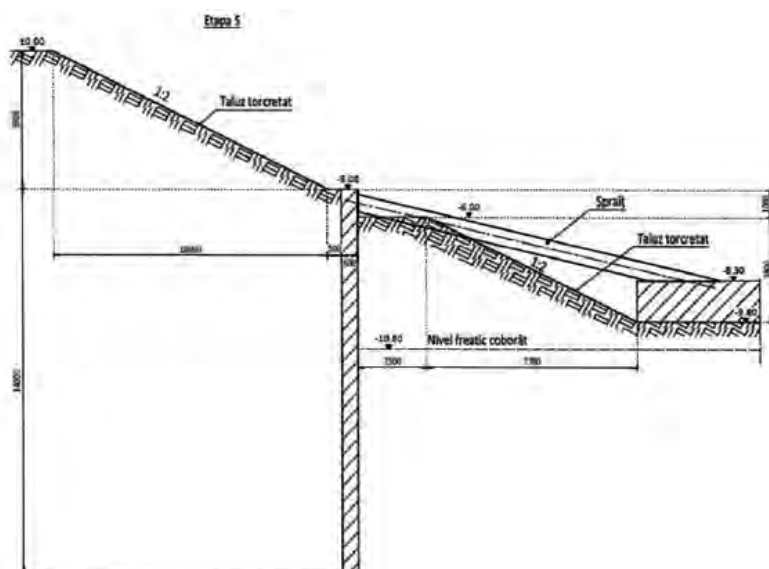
Sectiune faza de executie 5 – excavare cota finala cu contrabanchete su spraituri inclinate
